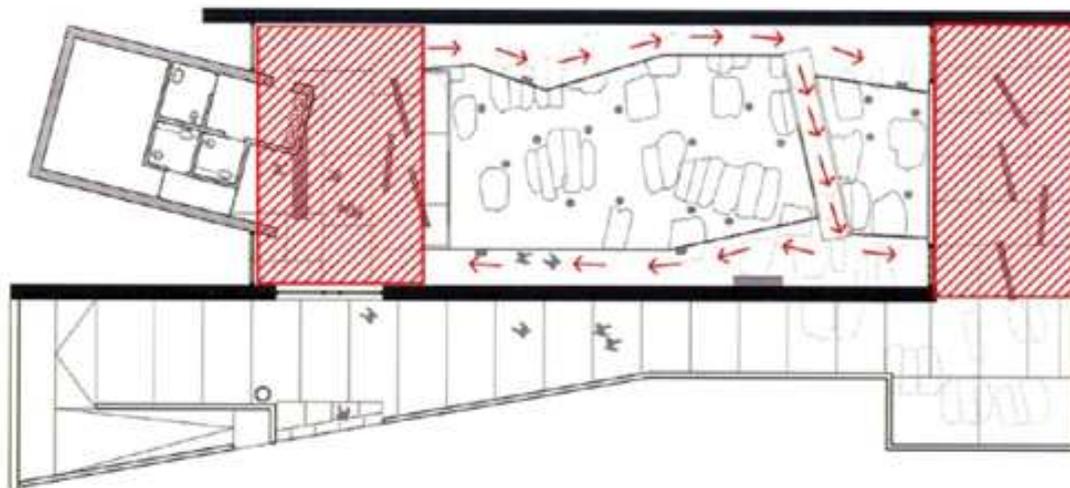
Pianta delle Necropoli di Pill' E Mata.
